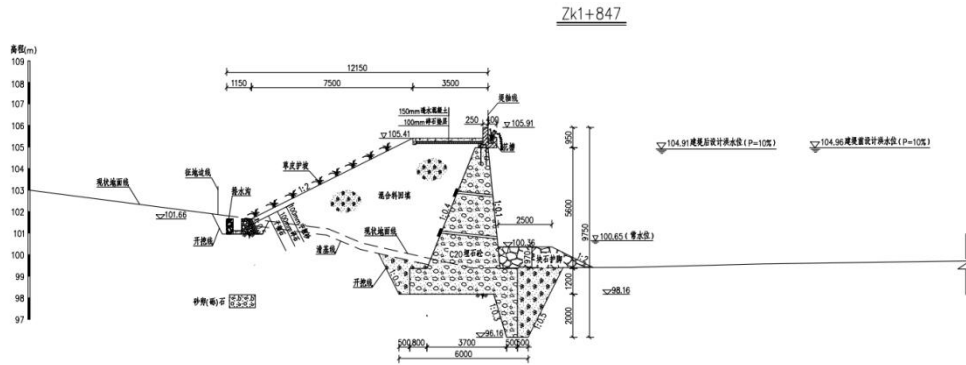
草皮护坡+混凝土挡墙 6.8m+块石护脚
